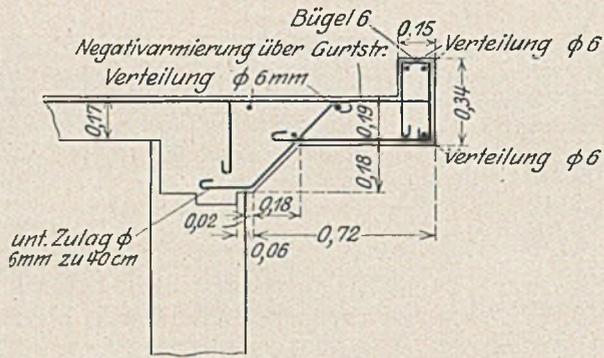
Armierung der Gesimskonstruktion. Schnitt B.
